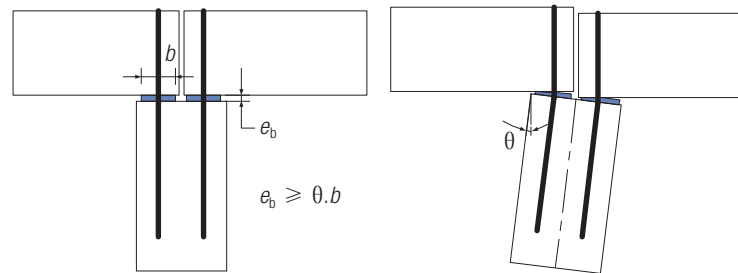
Déplacements dans un assemblage poteau-poutre articulé
